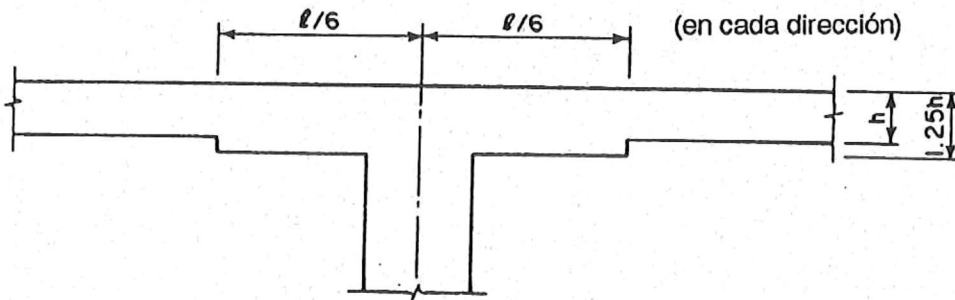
Detalles de ábaco (Sección 9.5.3.4)
